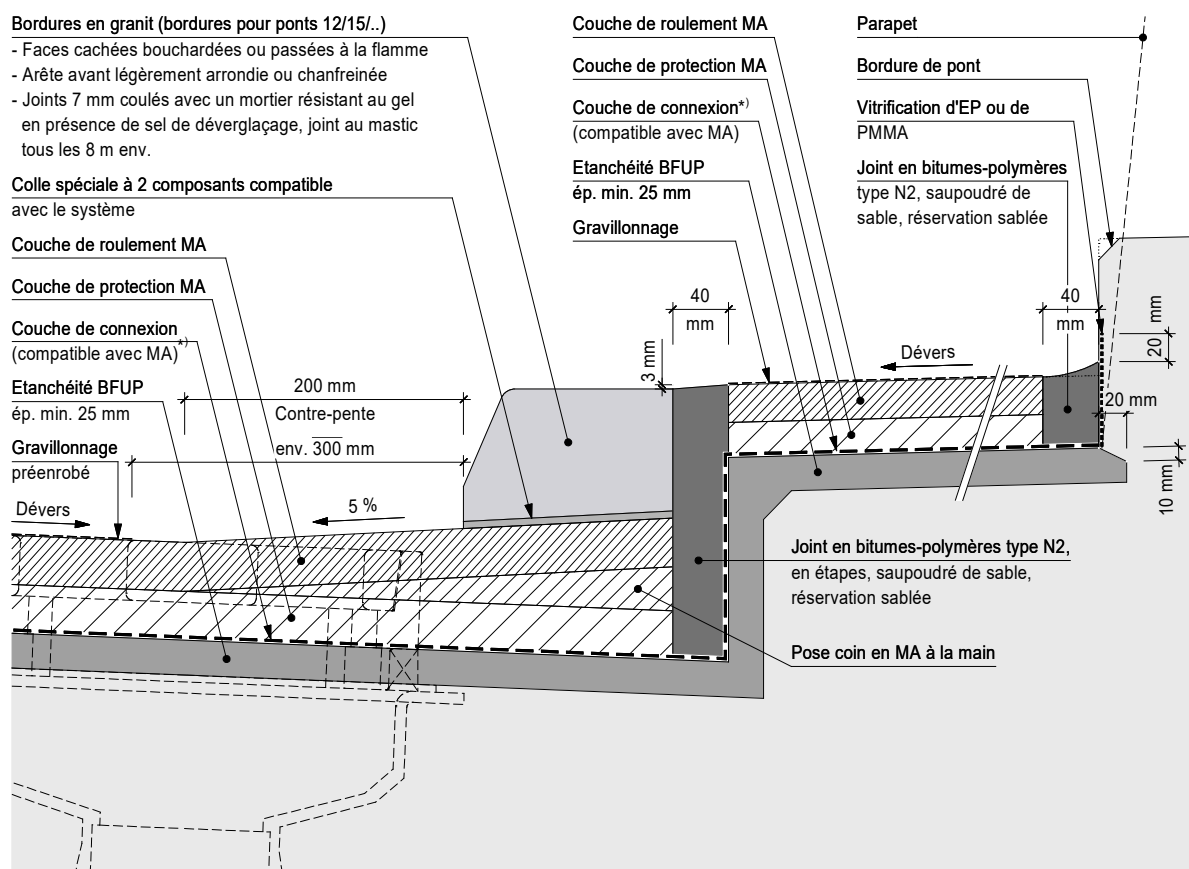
Système d'étanchéité BFUP - Raccord aux trottoirs - Bordure de trottoir collée - Point bas
